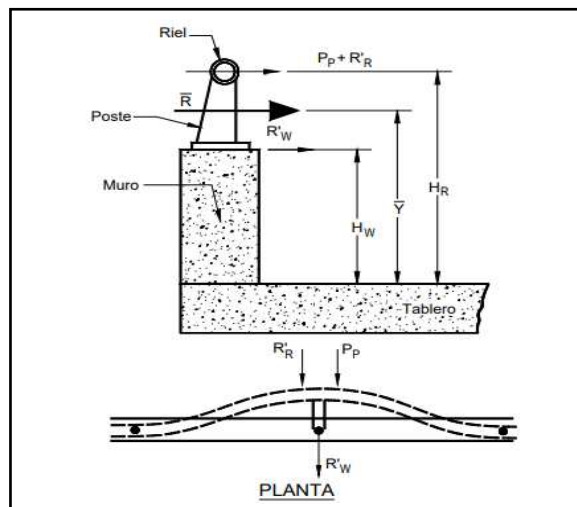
Análisis del conjunto formado por un muro de hormigón y un riel metálico con un impacto justo en el poste de la protección
